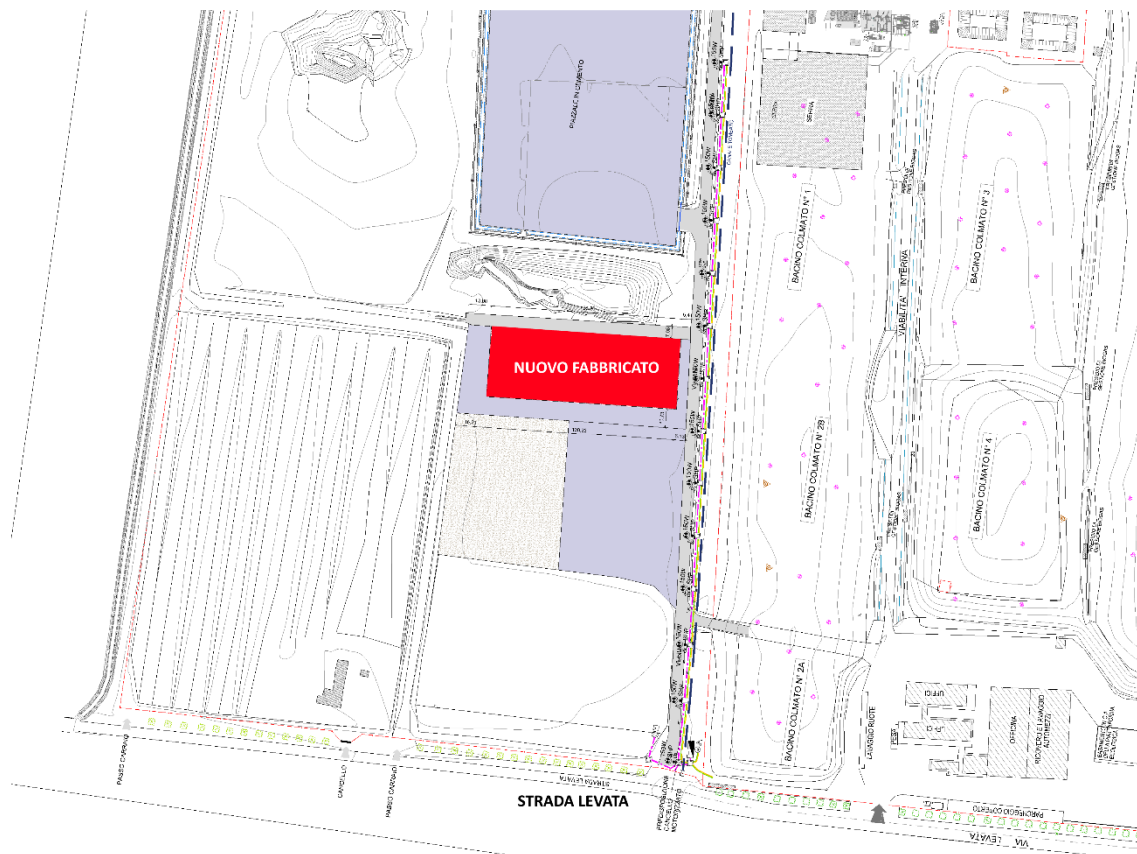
Localizzazione in pianta del nuovo fabbricato
